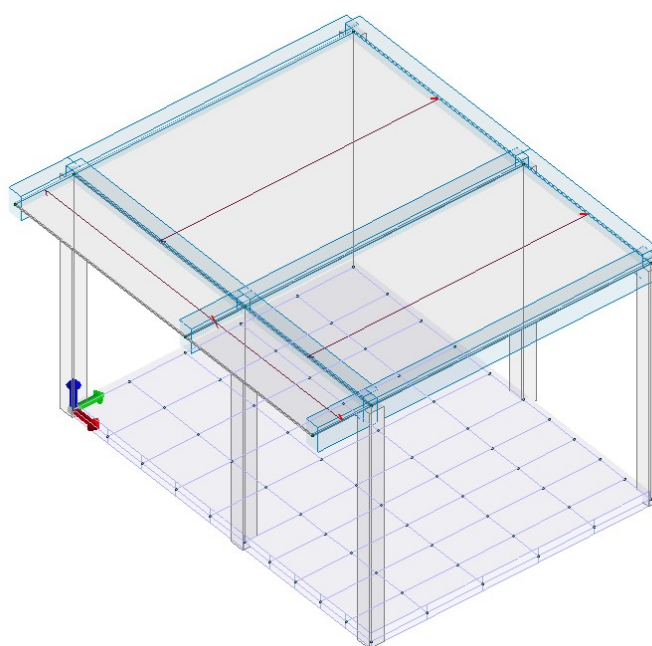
Telaio spaziale in cemento armato con fondazioni superficiali a platea.
